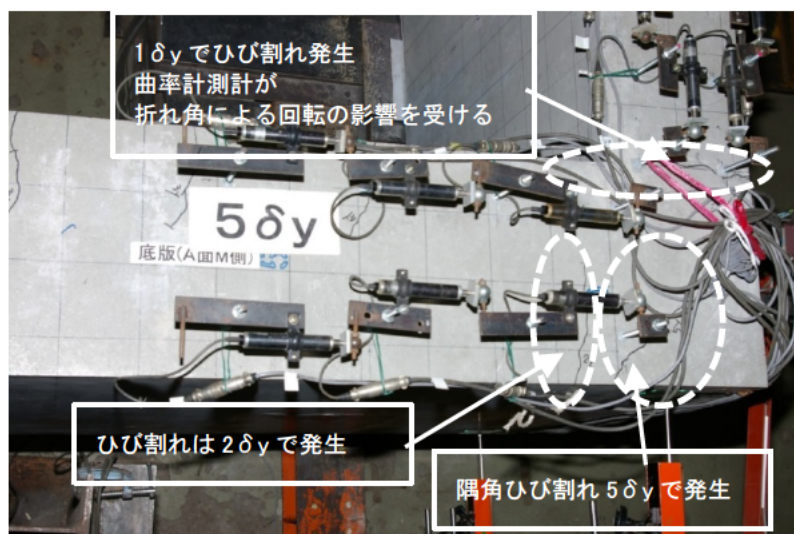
曲率計測範囲内に発生したひび割れ
